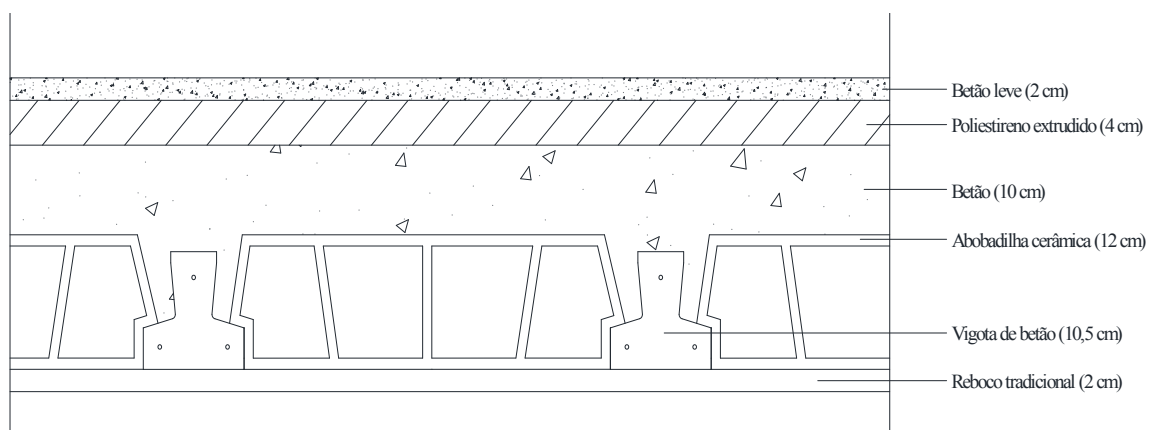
Laje de esteira de vigotas e abobadilhas.
